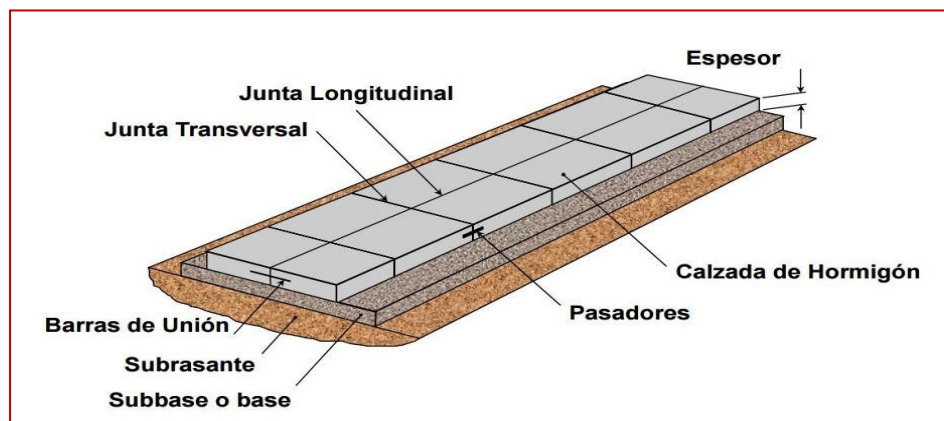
Esquema tipo del paquete estructural de un pavimento rígido
